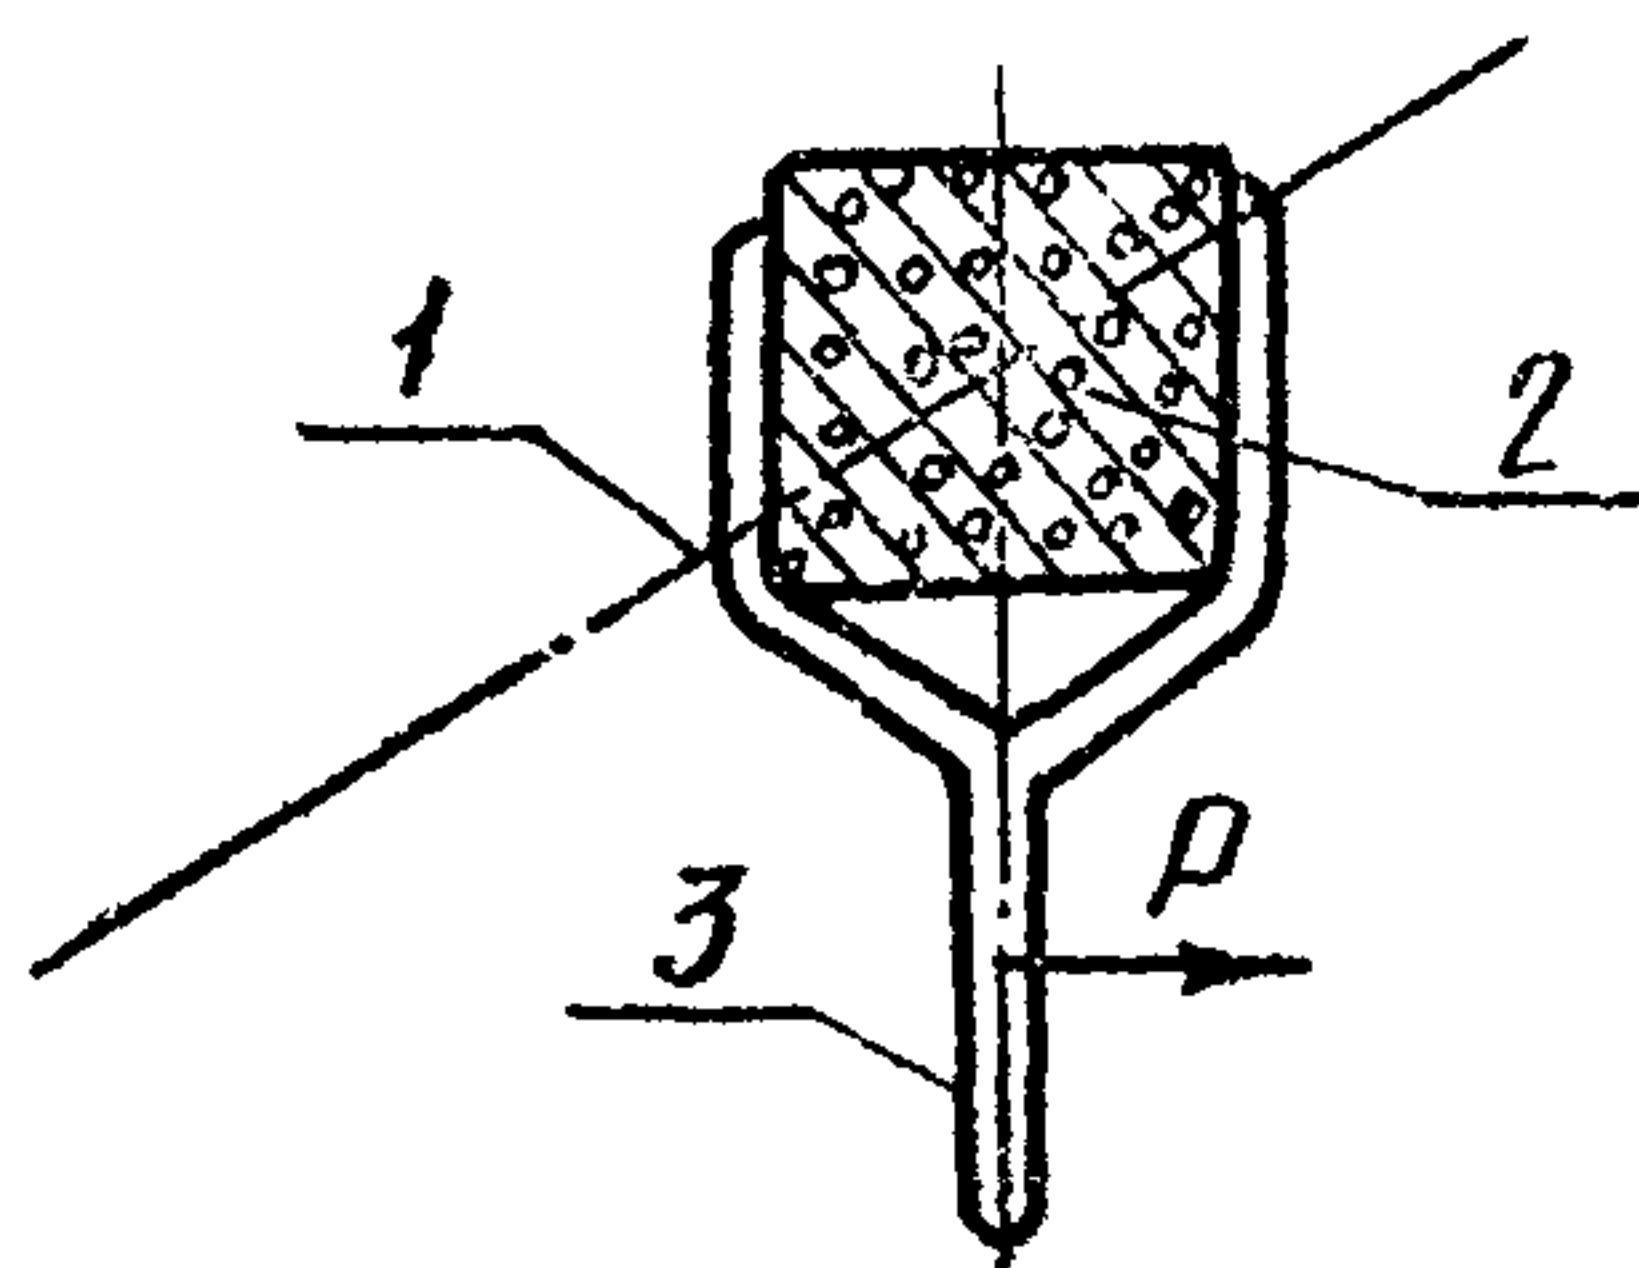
Рис. II. Схема поворота сваи свайным ключом: 1-ось свайного ряда; 2-свая; 3-свайный ключ; Р-направление поворота сваи
